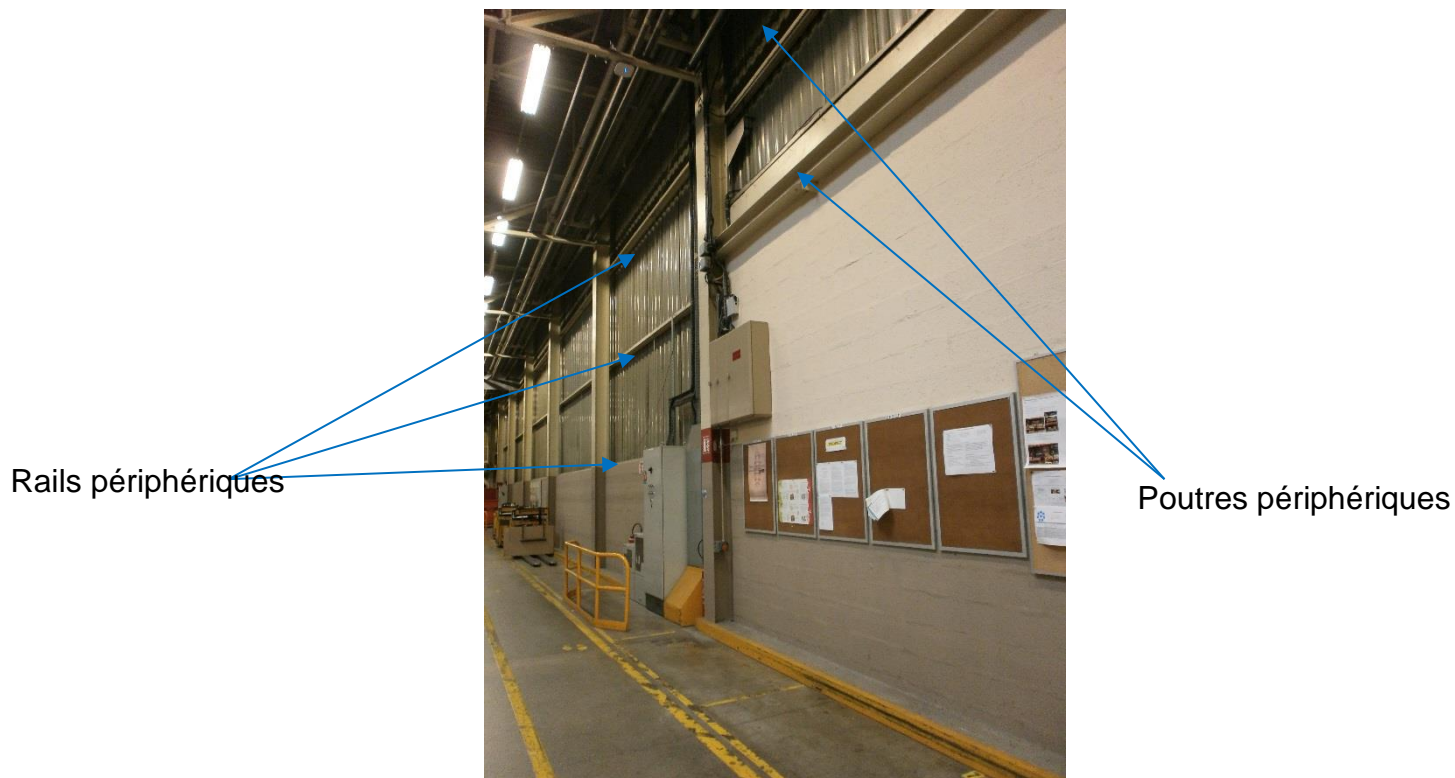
Position des poutres périphériques et rails dans le bâtiment A
